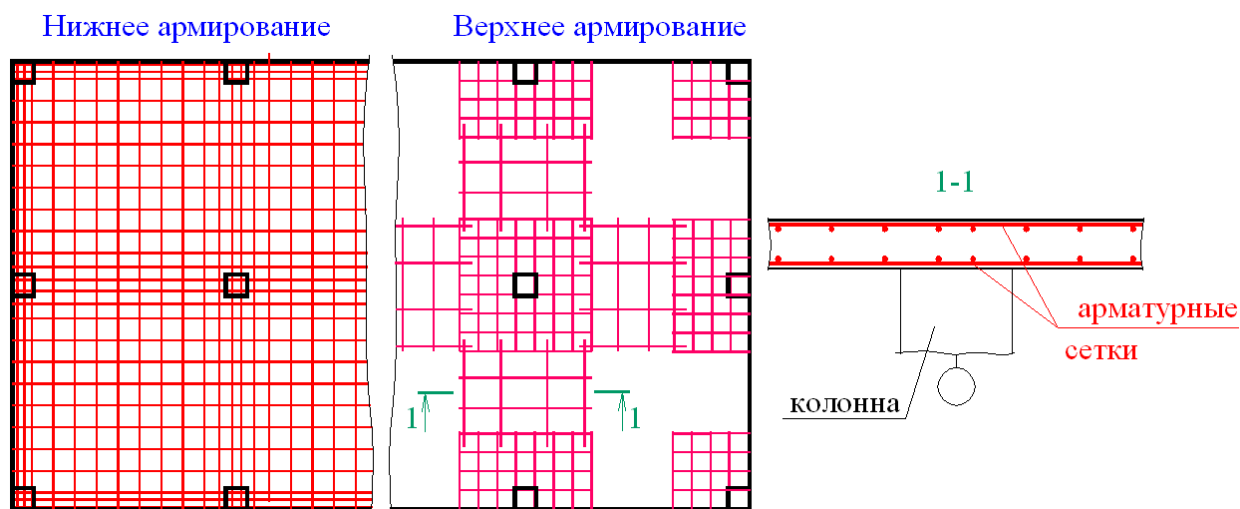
Традиционная схема армирования плоских монолитных плит перекрытий
